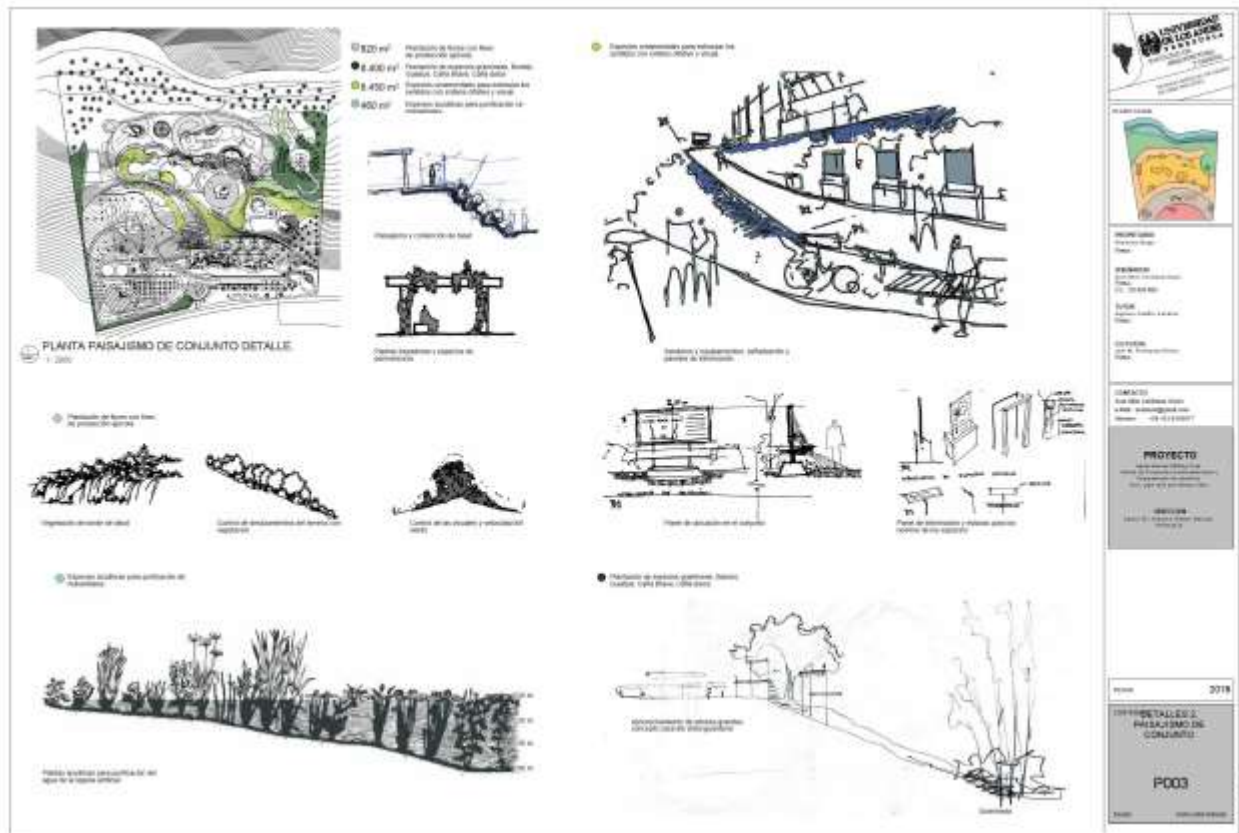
Detalles 2, paisajismo de conjunto P003.
